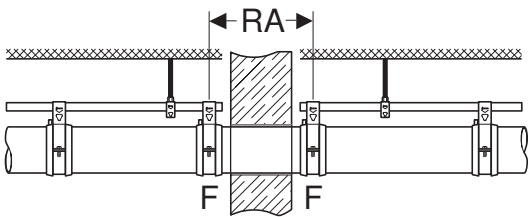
Distance entre les colliers en cas d'interruption unique du rail de suspension Geberit Pluvia
